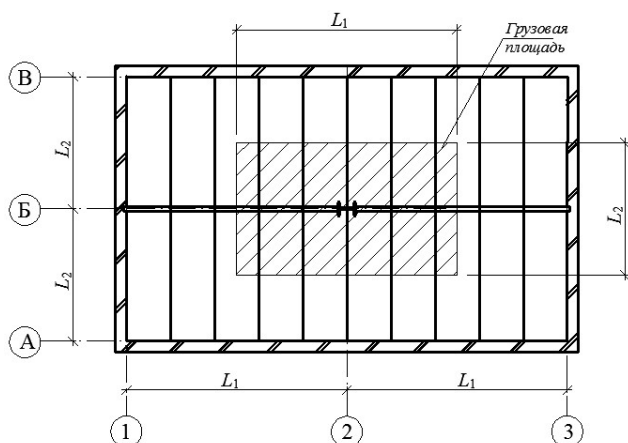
План перекрытия к расчету грузовой площади на колонну
